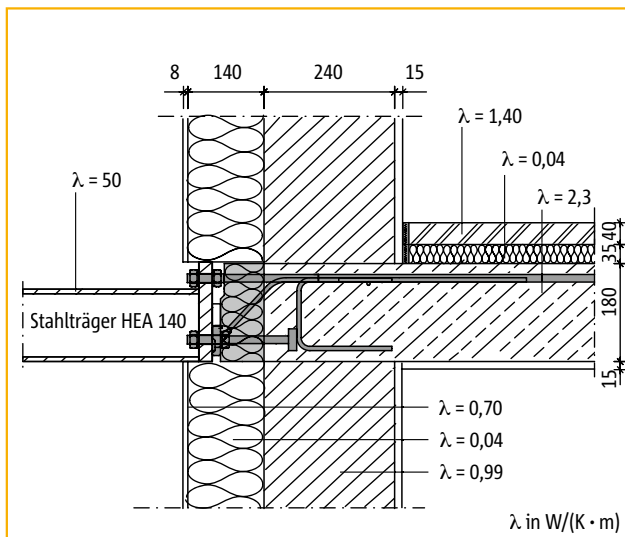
Anschluss Stahlträger HEA 140 mit Schöck Isokorb® Typ KS14 bei Wärmedämm-Verbundsystem
